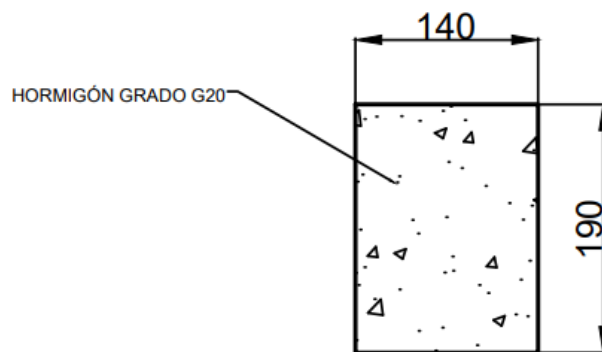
Diseño bloque con eco-ladrillo, vista frontal.
